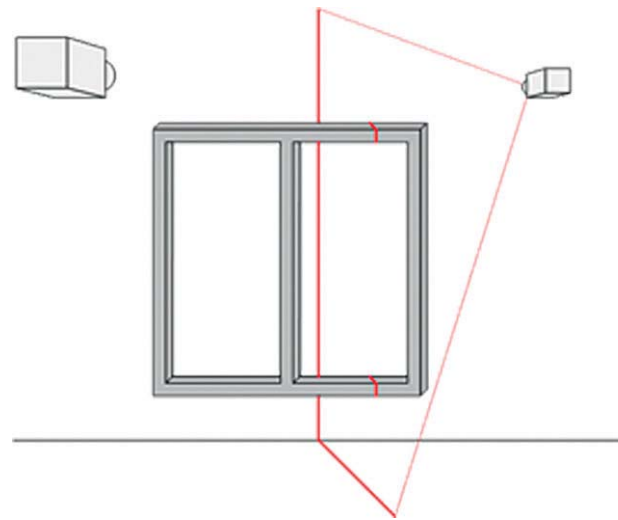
Erfassung der Fenster mit einem 3D-Scanner
